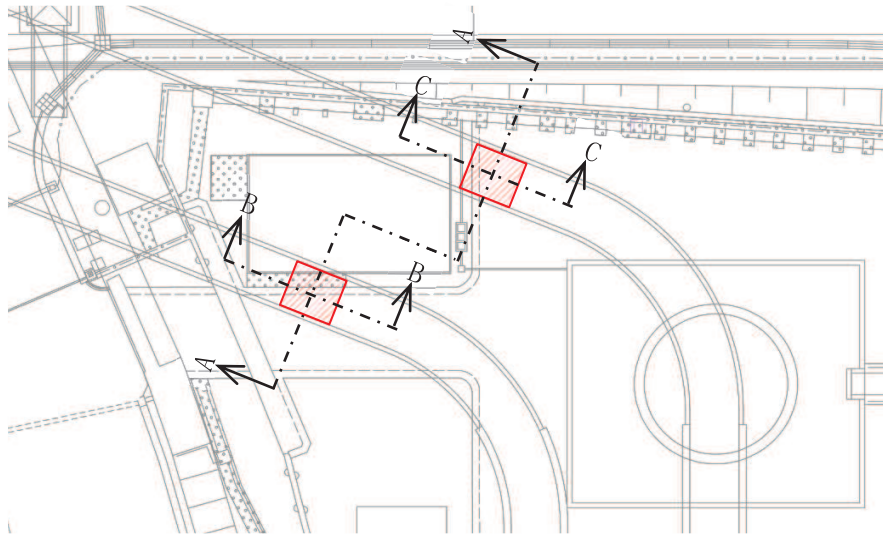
(1) 取放水路流路縮小工（第1号機取水路）（No.1）,（No.2） 平面図
